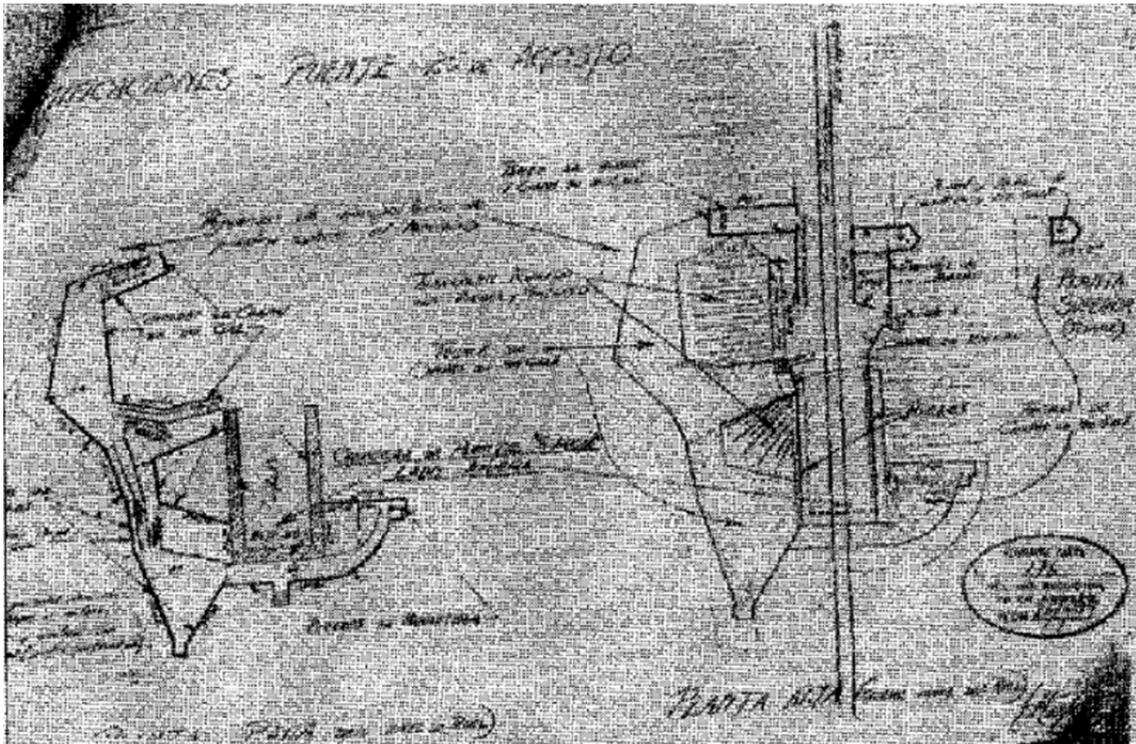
Plano del fortín, con su planta baja y alta (Fuente: Berriel 2009:234)
